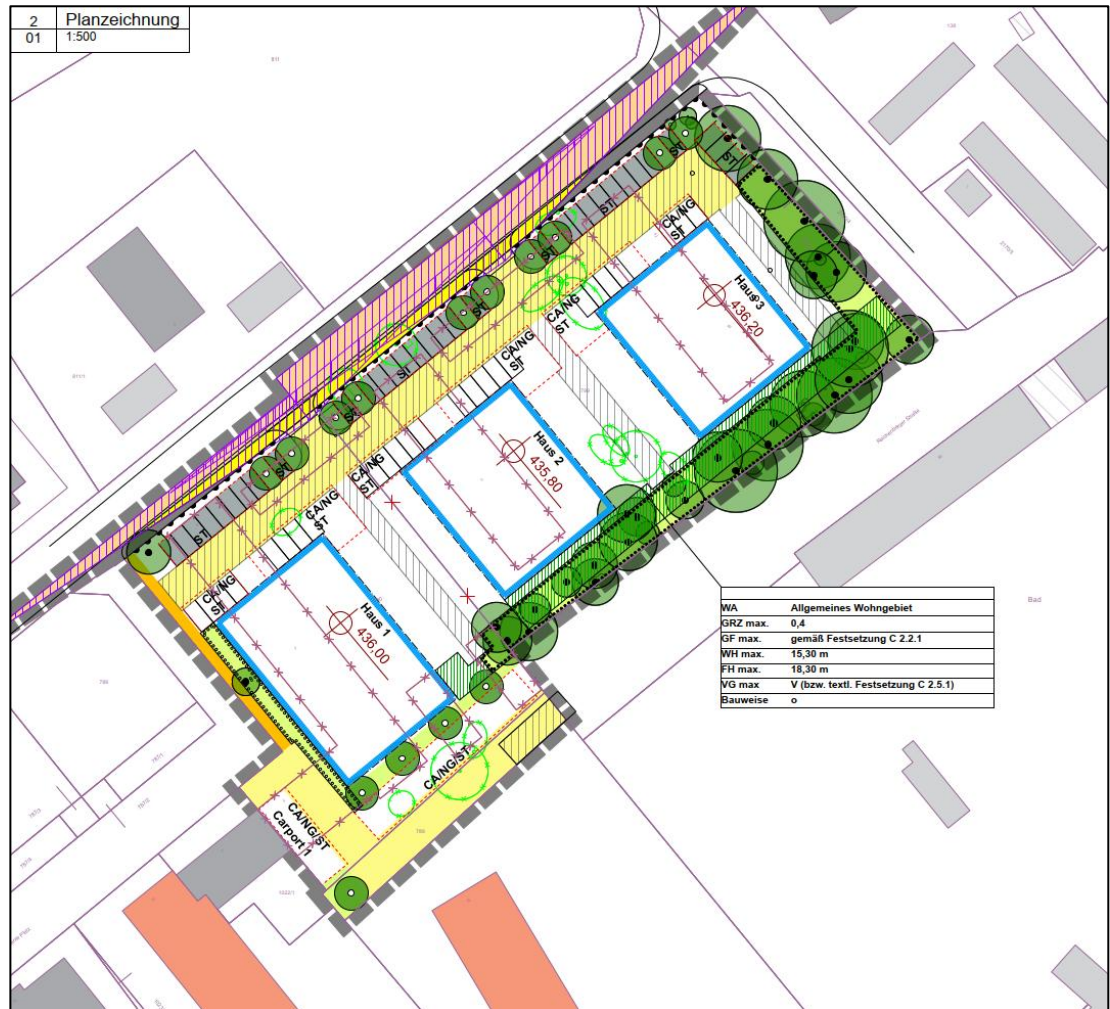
Planinhalt Bebauungsplan, Entwurf in der Fassung vom 08.05.2026
